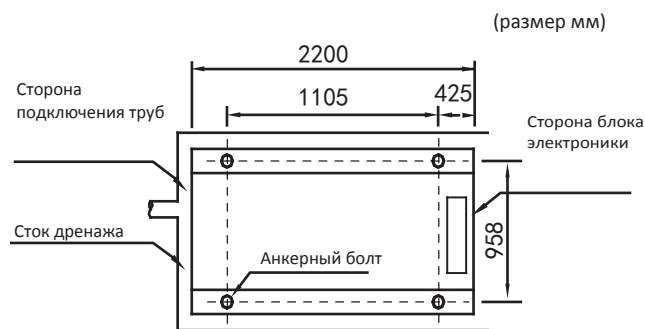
Вид сверху, принципиальная схема и установочные размеры MDC-SU60M-RN1L
